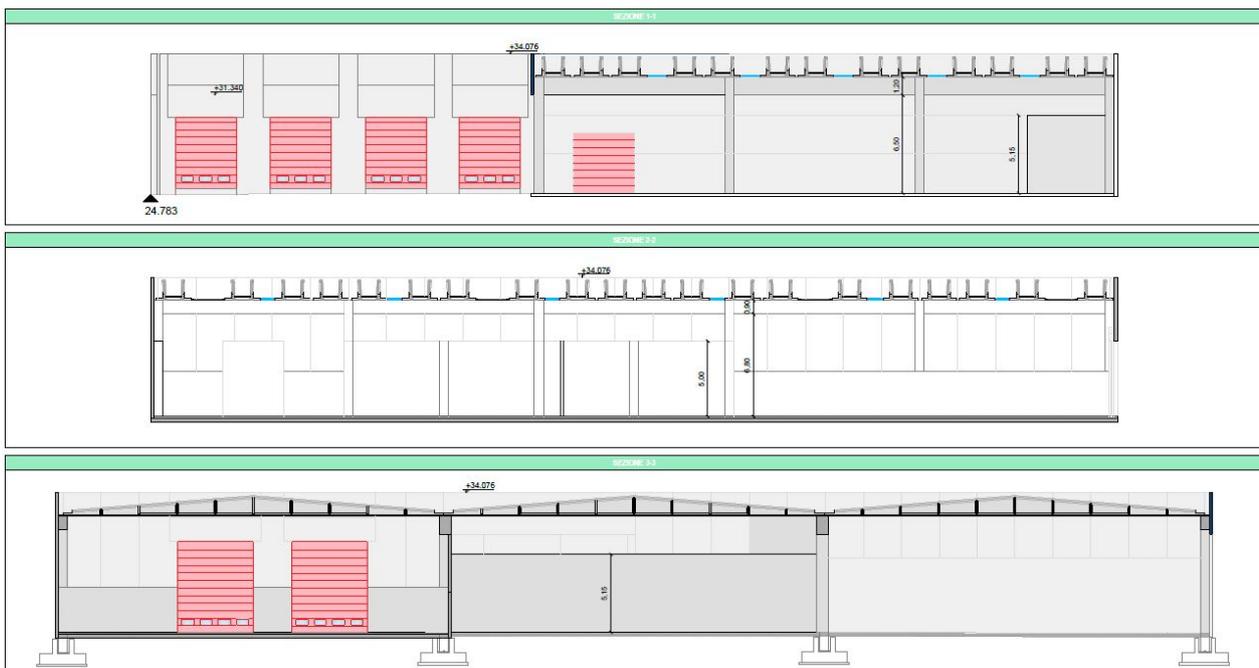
Sezioni trasversali e sezione longitudinale capannone nella configurazione di progetto
